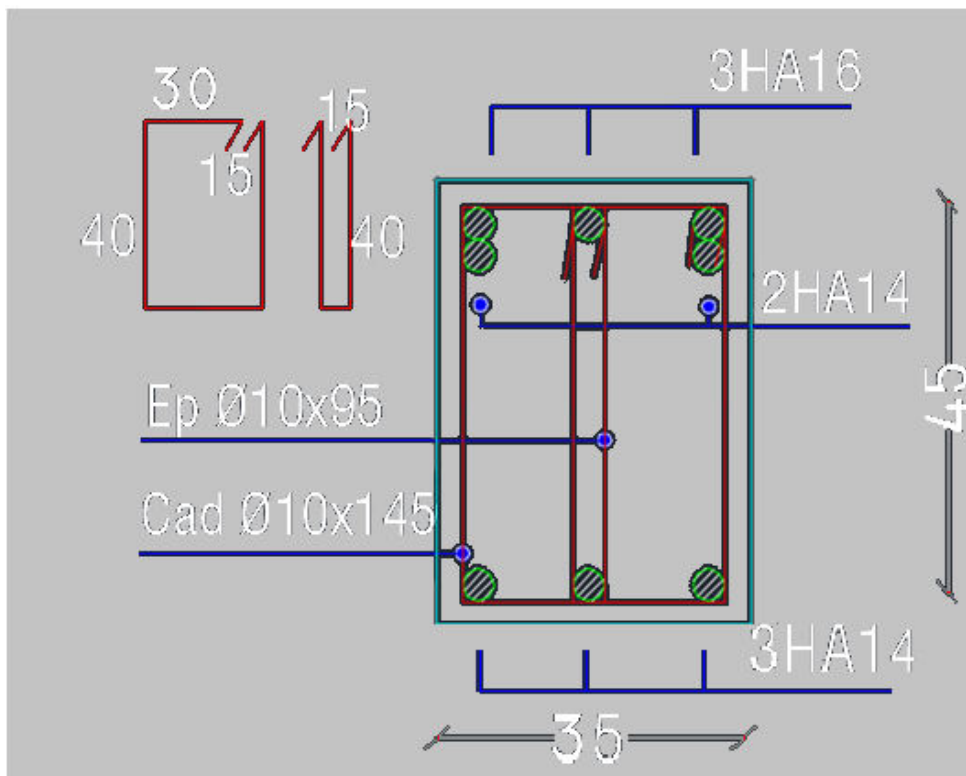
Ferrailage des poutres principales au niveau d'appuis de 2<sup>ème</sup> à 7<sup>ème</sup> étage.
